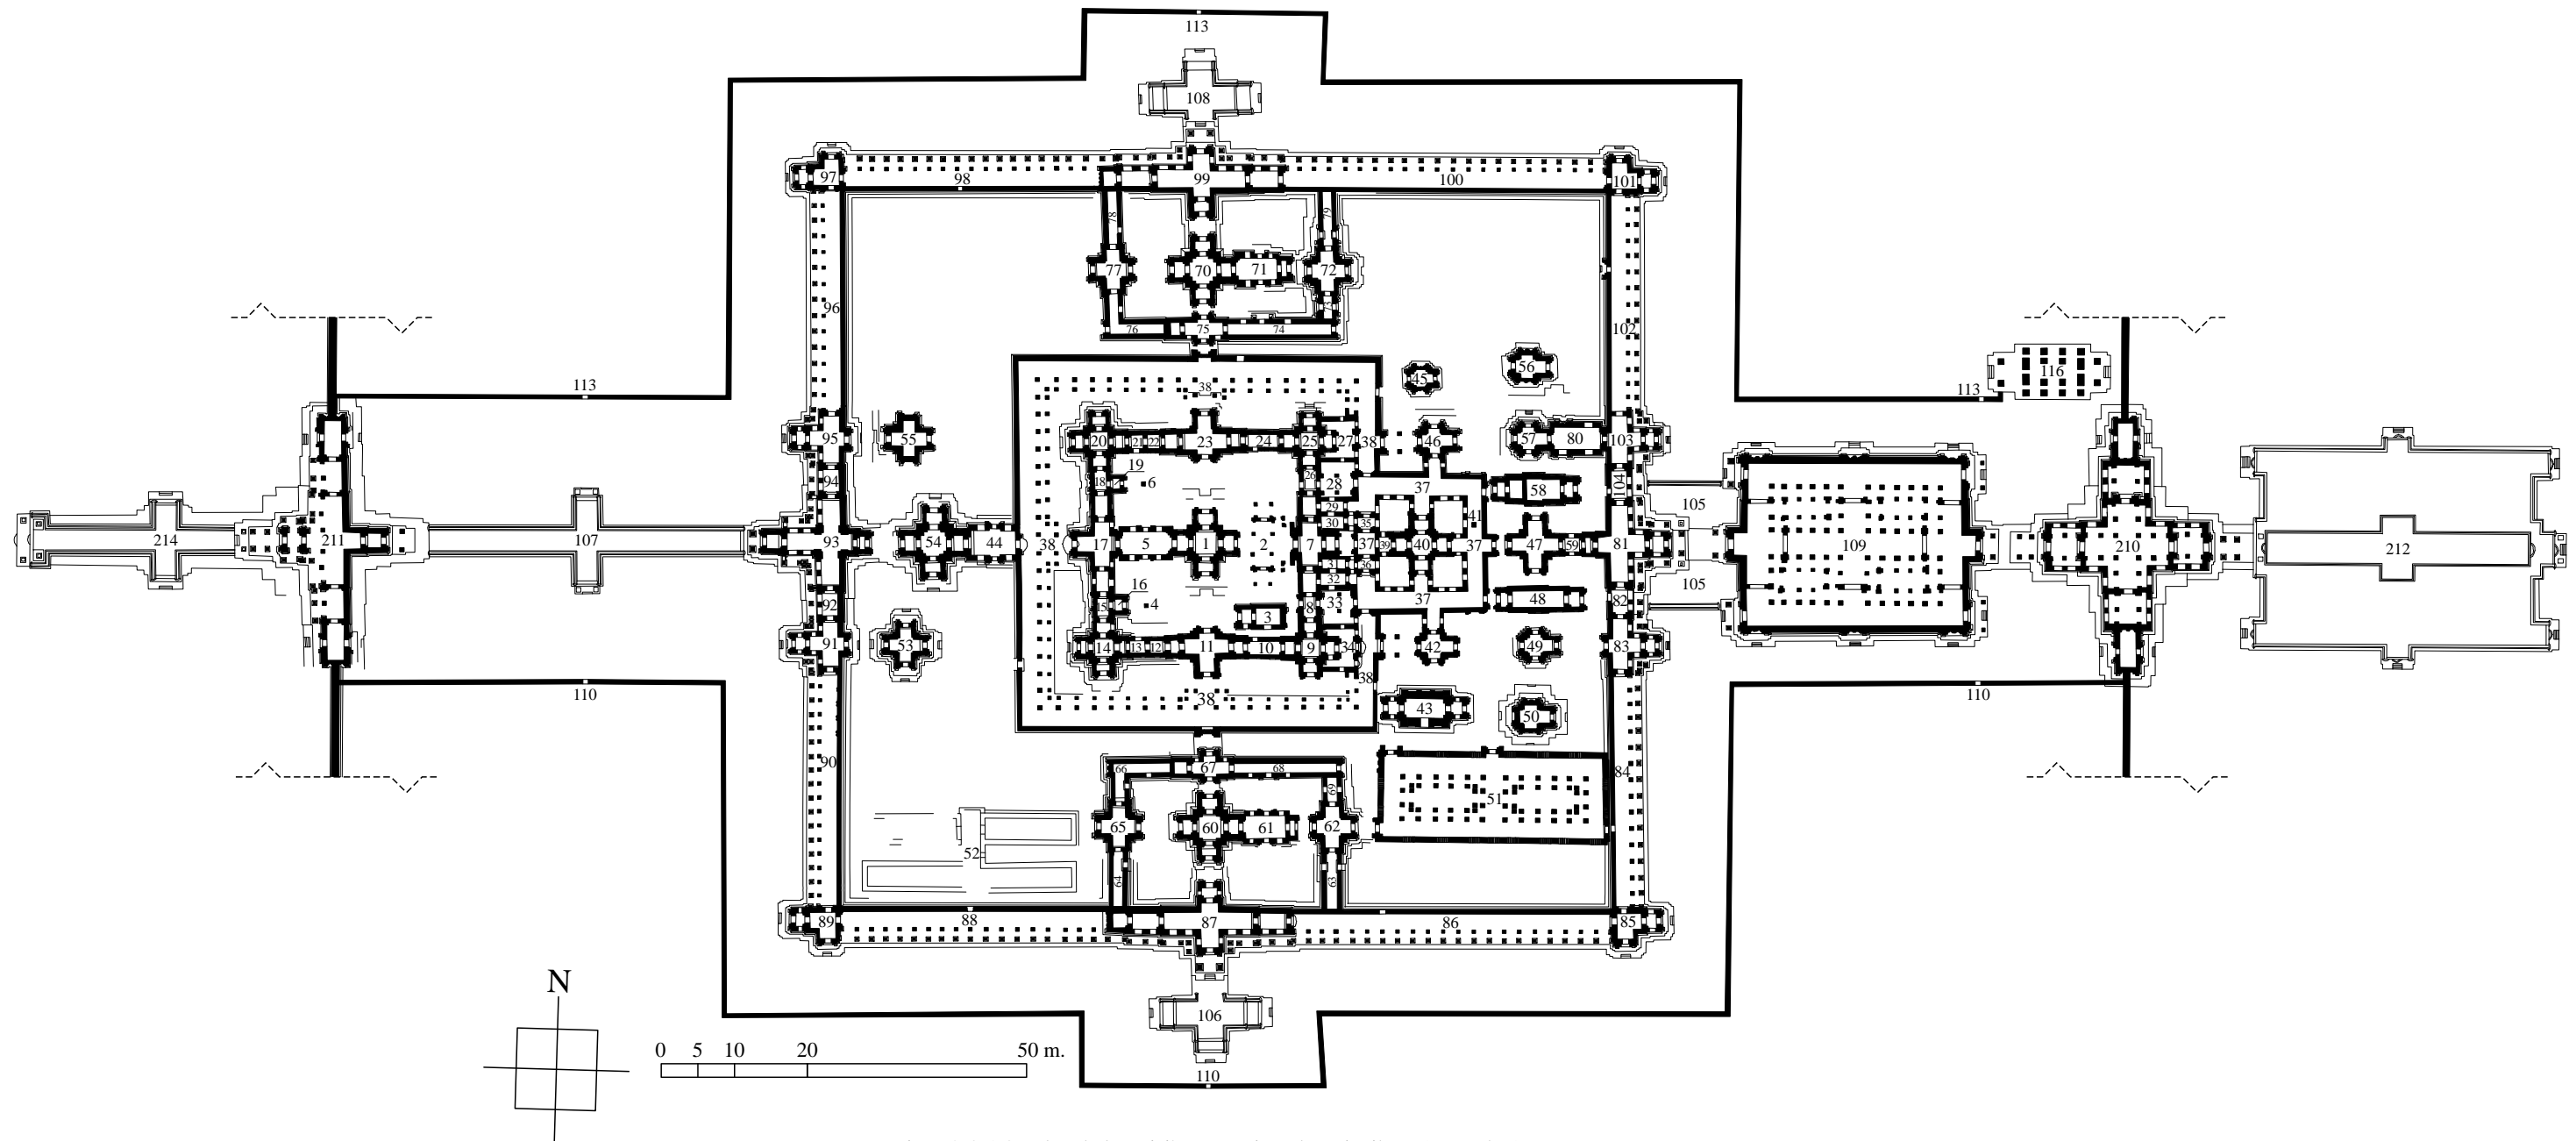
Plan de la troisième enceinte de Rājavihāra (Ta Prohm)
